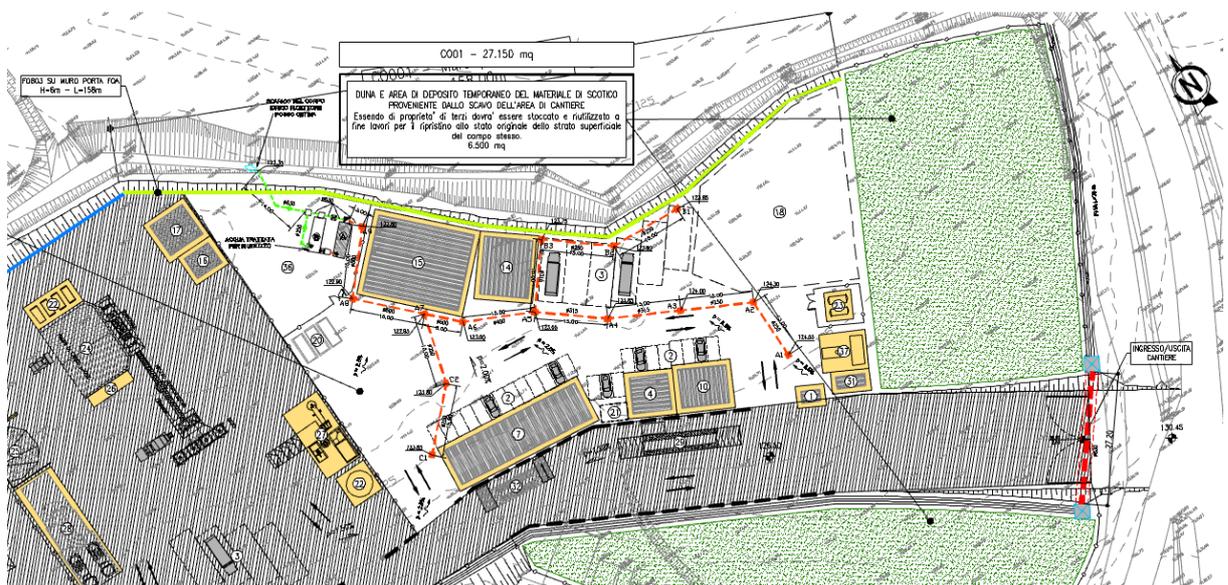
Planimetria reti idrauliche del CO01 – Cantiere operativo e area di deposito temporaneo terre
